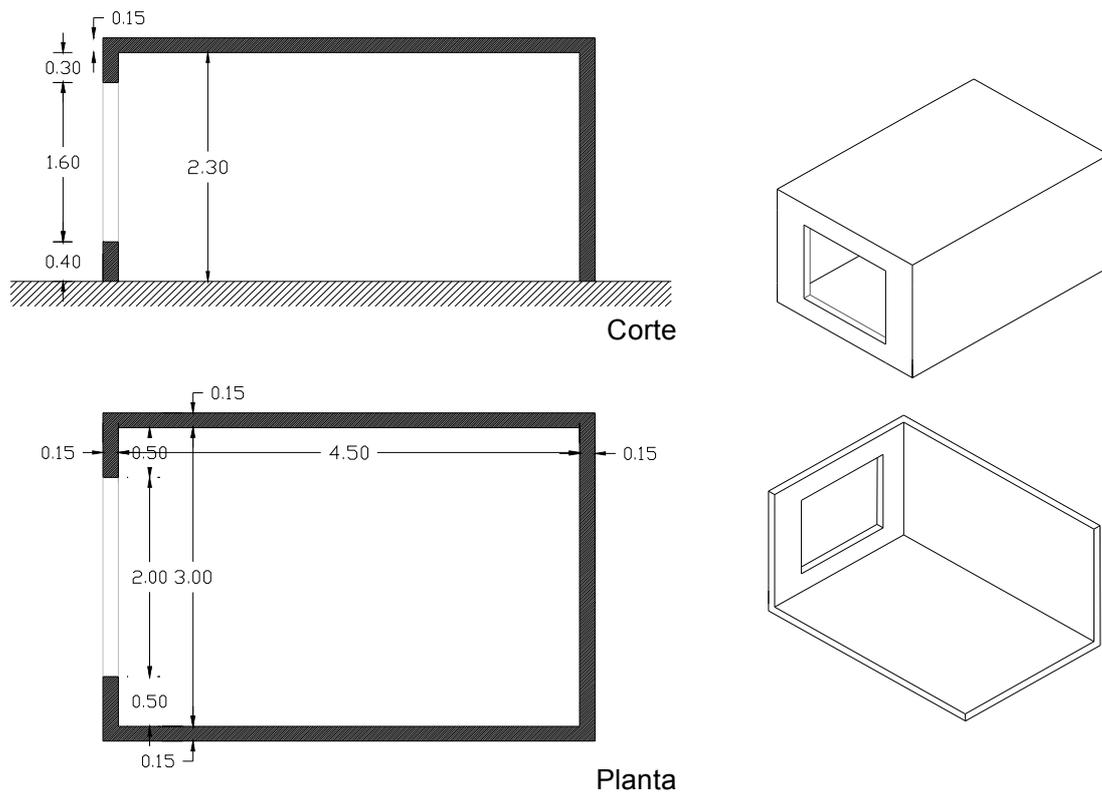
Sala de referência em corte longitudinal, planta e isométrica, externa e interna, mostrando as dimensões e configurações da sala.
